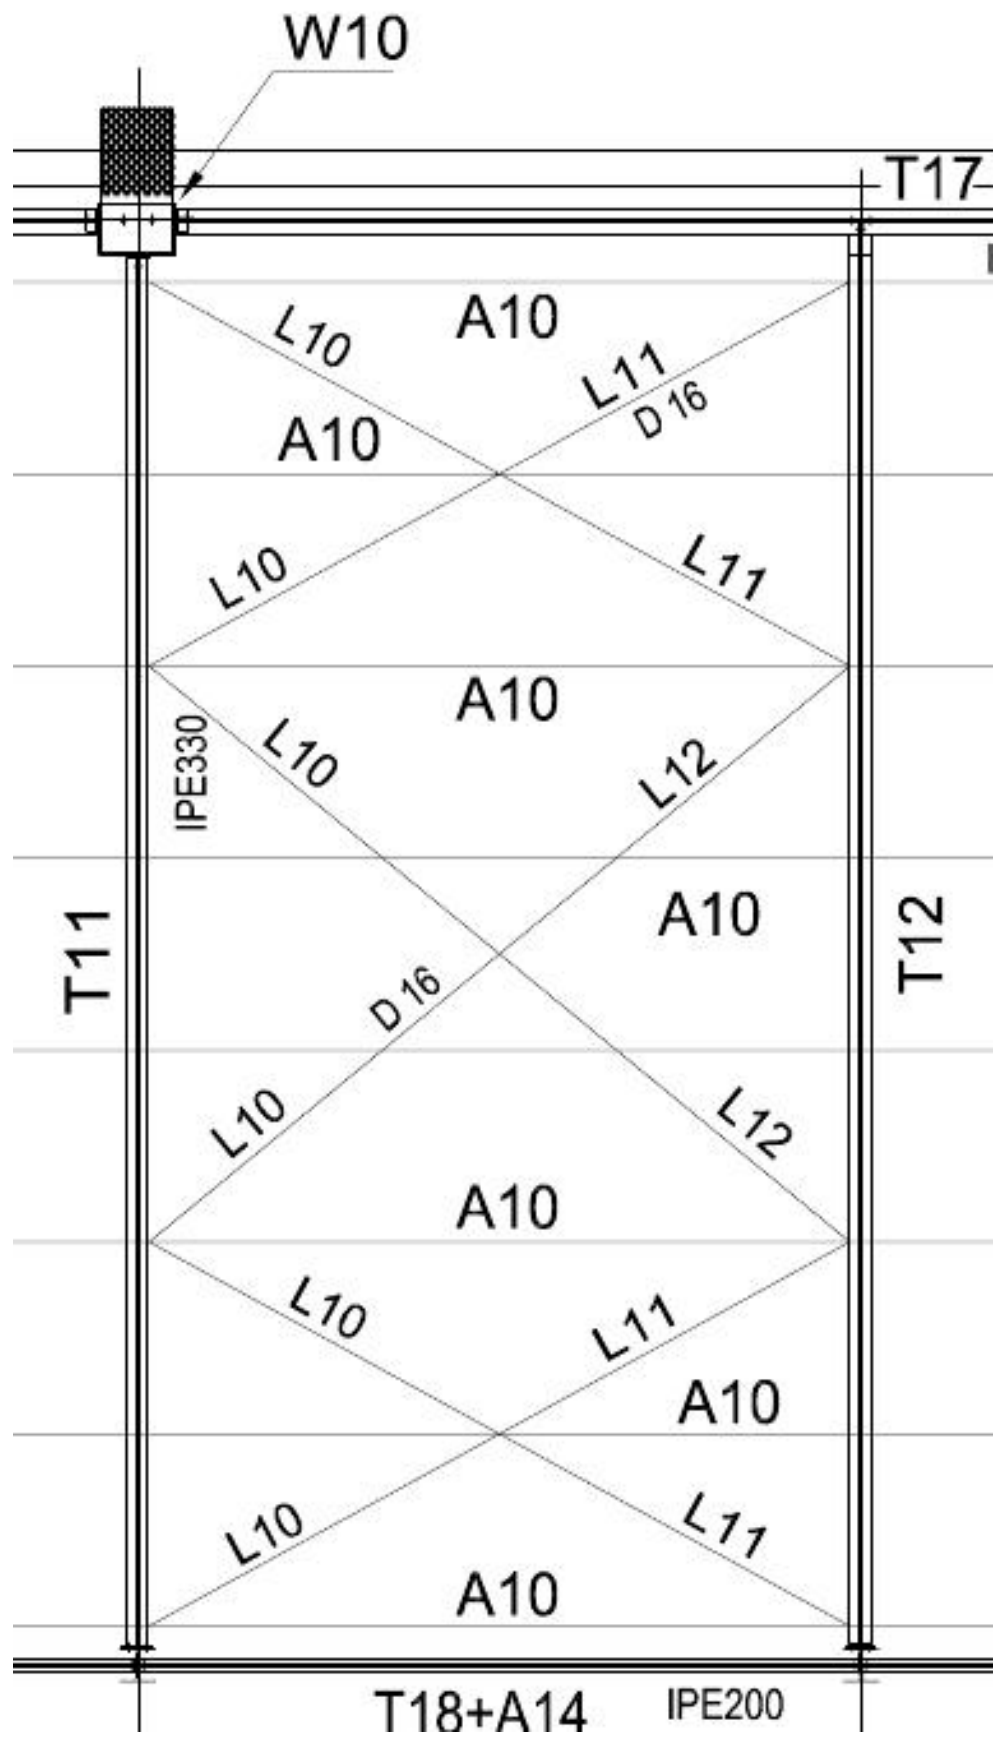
Particolare di A.2001.a.sa.T02 - Piante e prospetto - Schema tipo controventi di copertura
